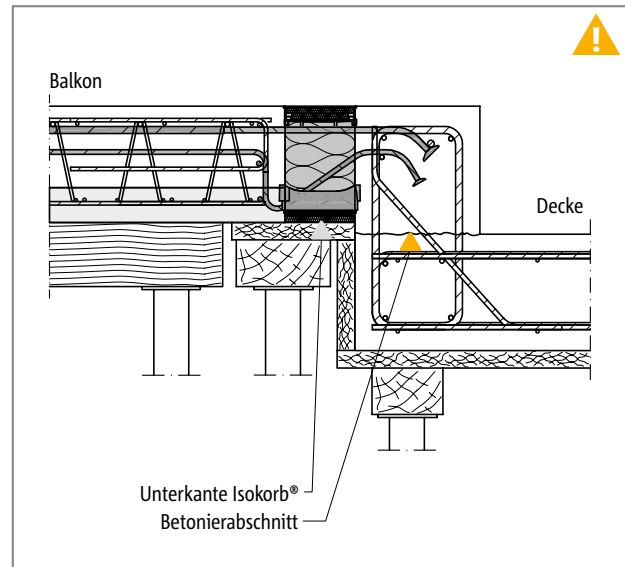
Schöck Isokorb® XT Typ K-O-F: Balkon mit Elementplatten und mit Höhenversatz nach oben
